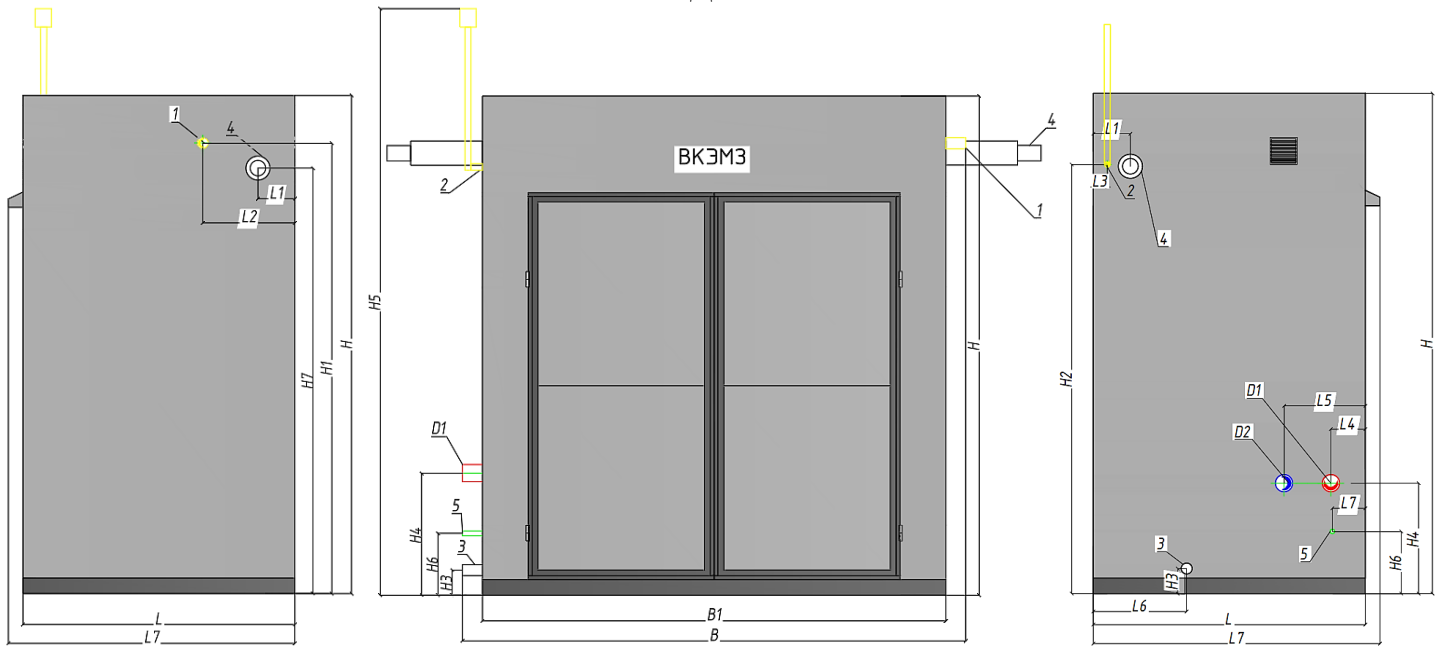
Габаритно-присоединительные размеры котла наружного размещения
